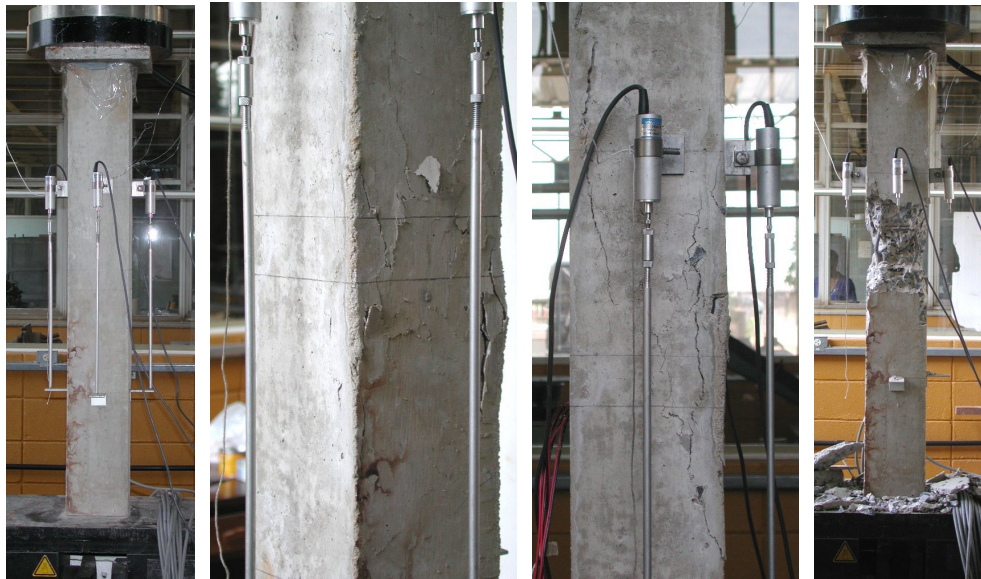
Fotos do pilar original de seção transversal quadrada
